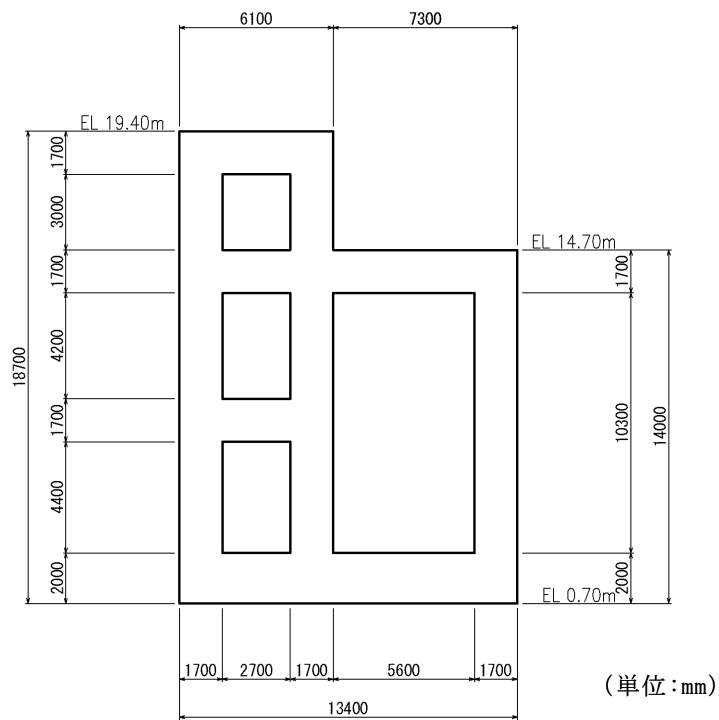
第 1 ベントフィルタ格納槽概略配筋図 (A-A 断面)
